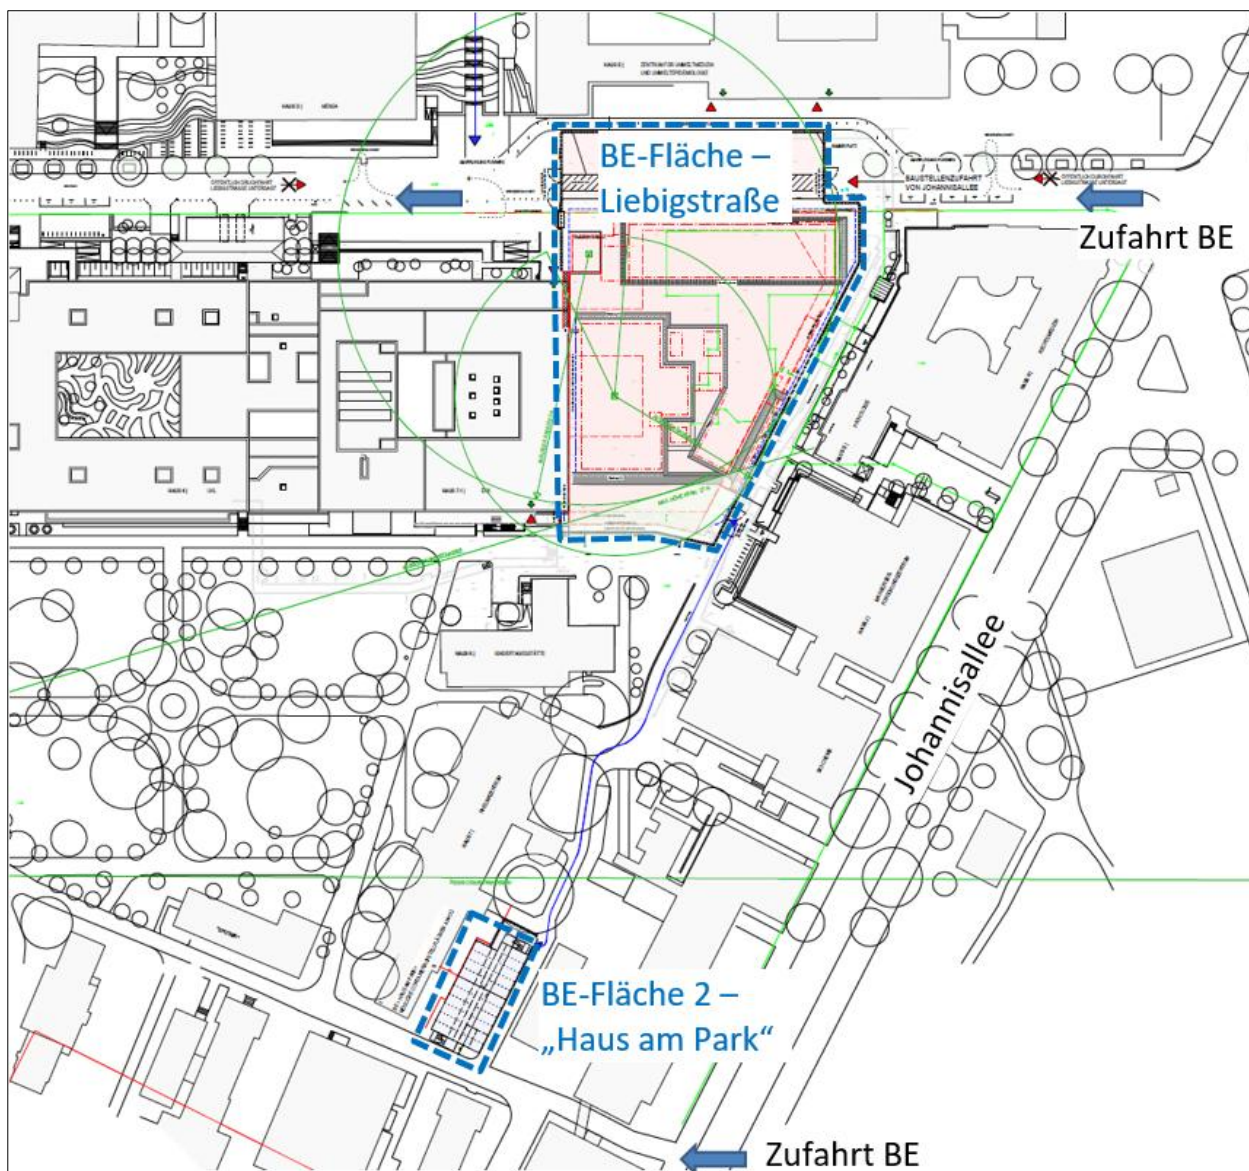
Lageplan, Baufeld SIR und mögliche Baustelleneinrichtungsflächen
